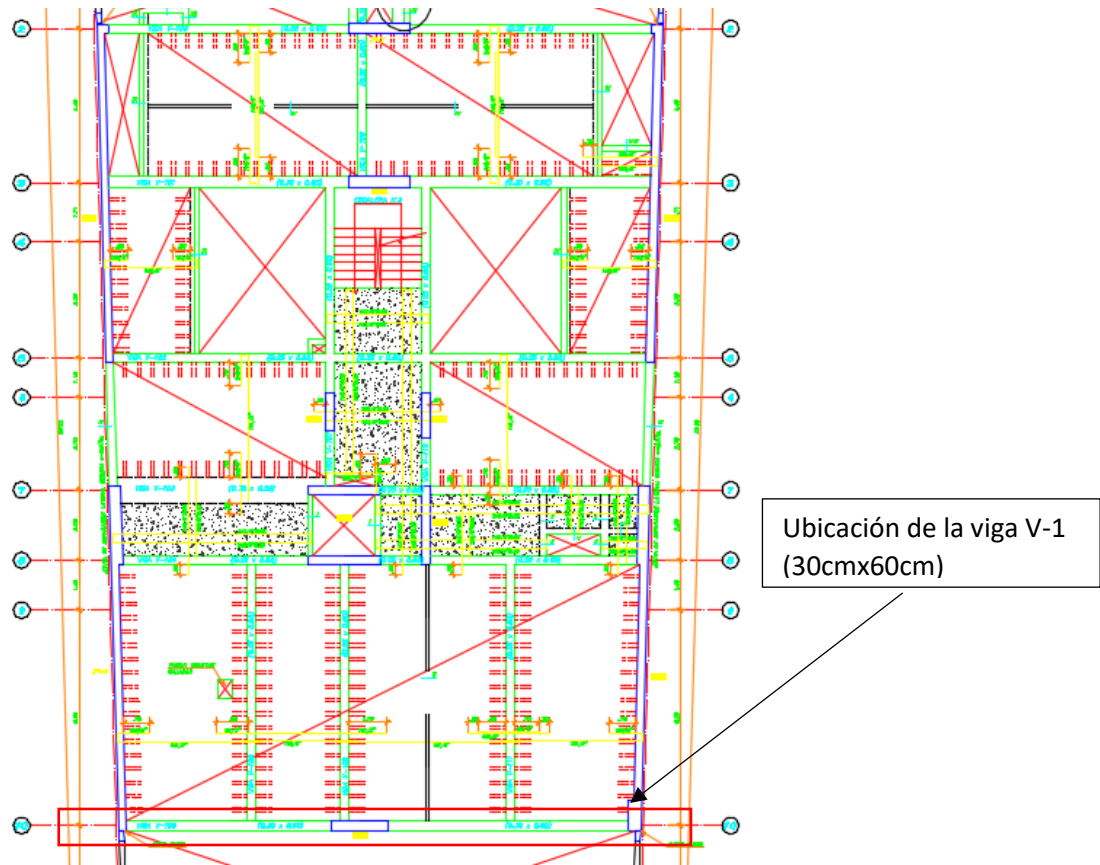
Ubicación de la Viga V-1 (30cmx60cm) en planta, 4to nivel
